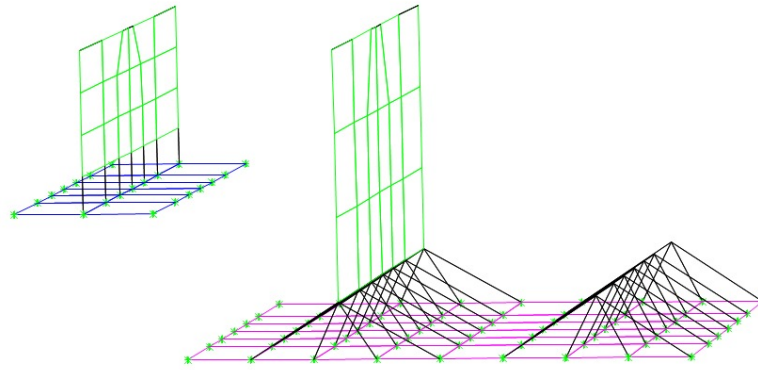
Modello fondazione piedritto generale e fondazione imposta arco con relativi basamenti
